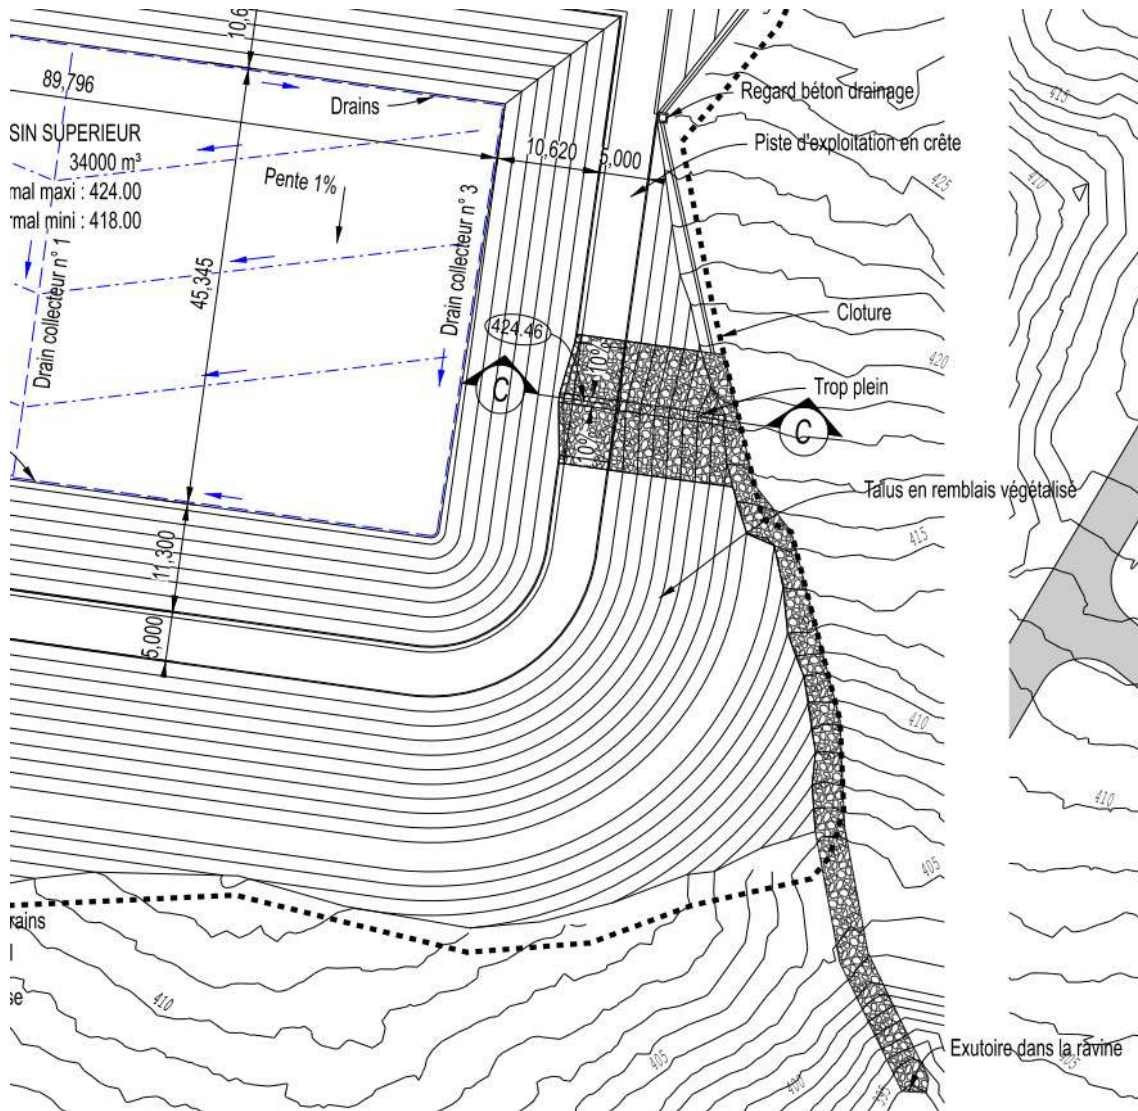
Zoom sur la vue en plan du bassin supérieur (source : ISL Ingénierie)
